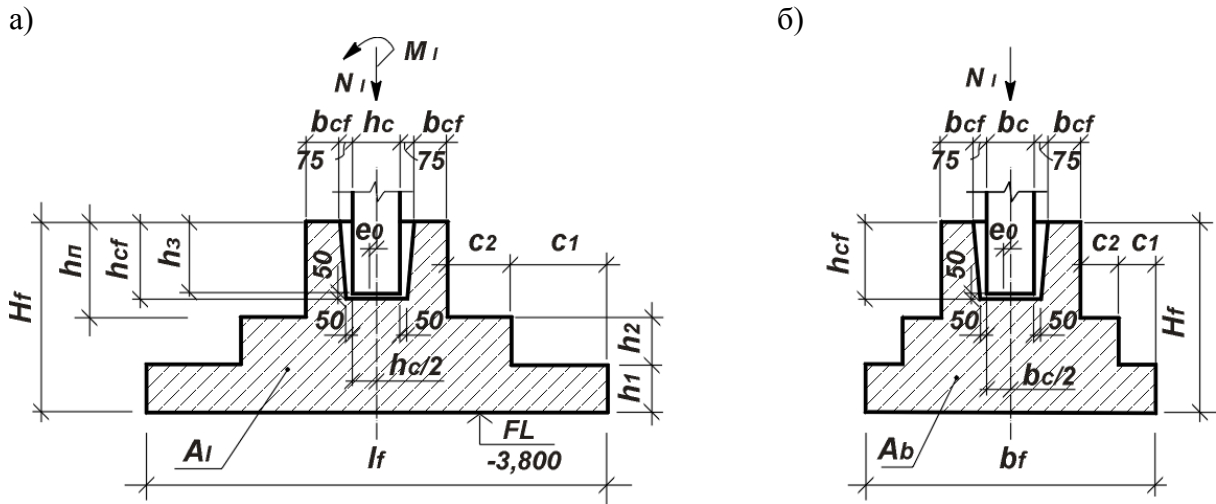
К расчету плитной части фундамента на раскалывание:
